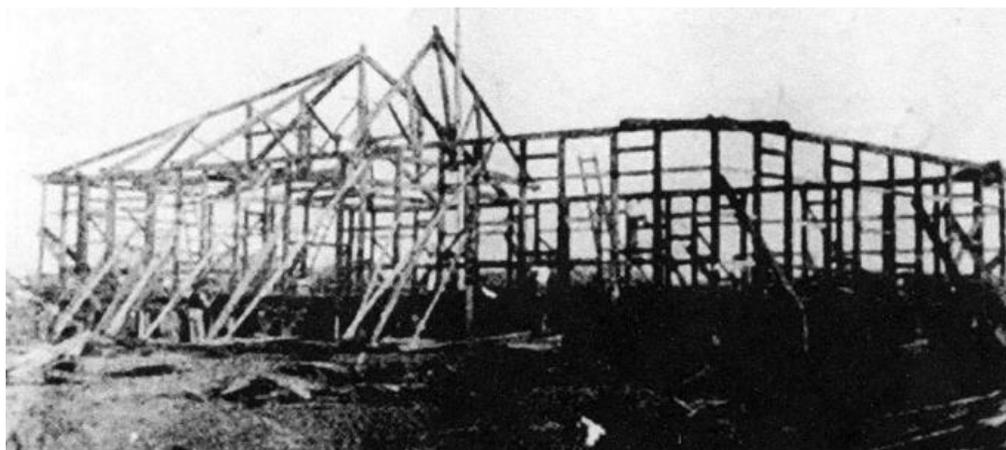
Demonstração em corte da estrutura de cobertura escalonada em casas do Vale do Ribeira
